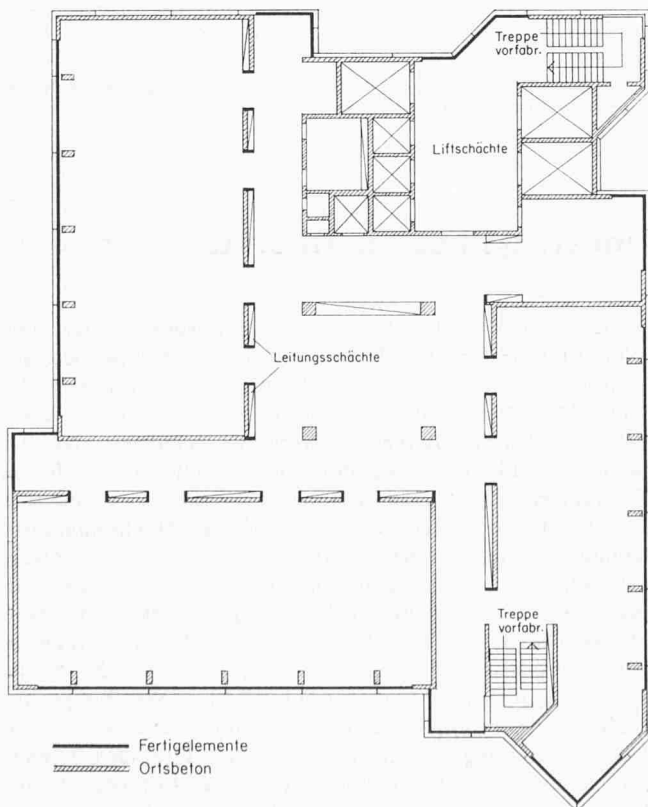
Geschossgrundriss 1:350 mit Angabe der vorgefertigten Einzelteile
